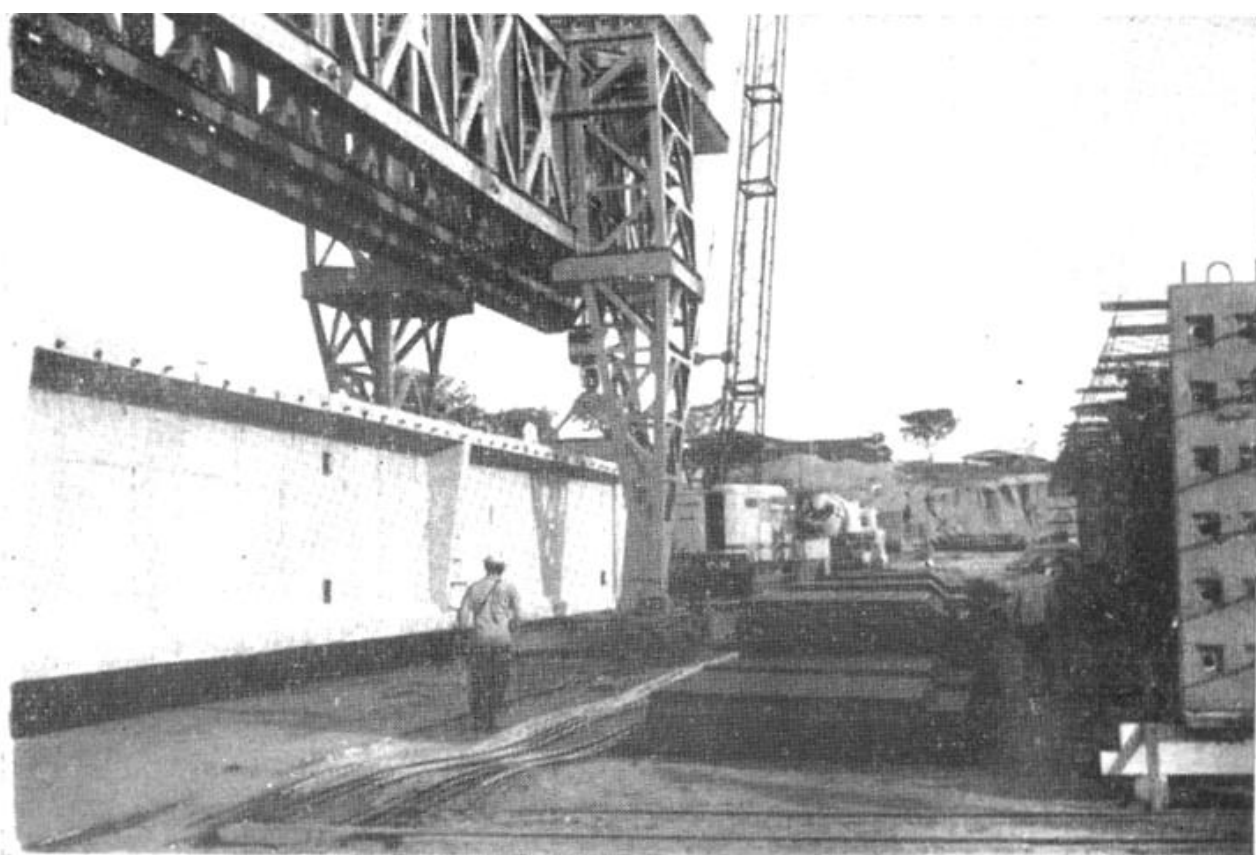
Vista parcial do coneteiro mostrando parte da treliça
